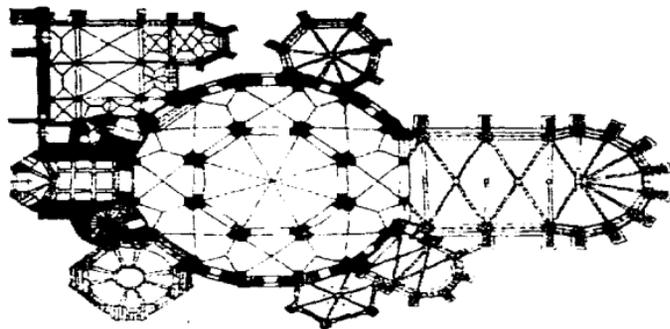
Palacio imperial de Aquisgrán. Planta y corte
